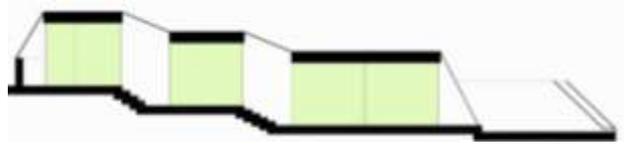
Sección vivienda Jeffe House, con la modulación.
